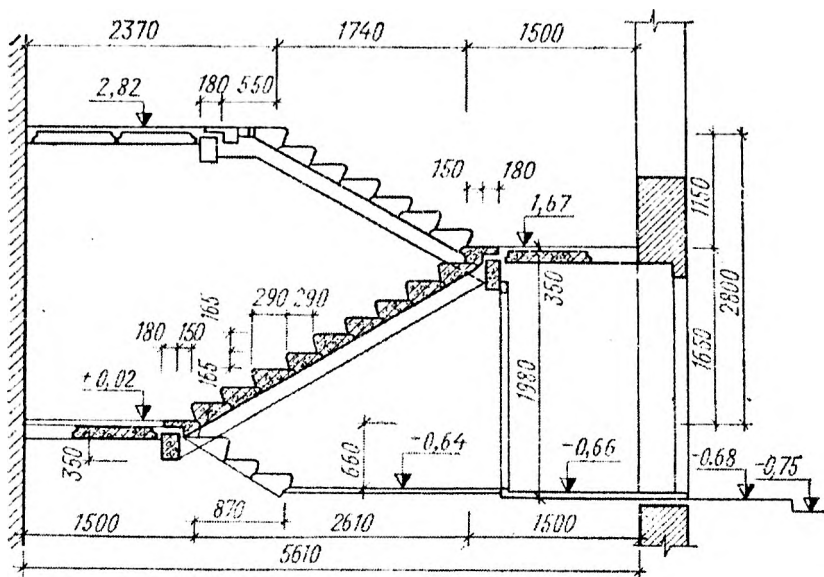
Лестница из сборных мелкогазмерных элементов при высоте этажа 2,8м
